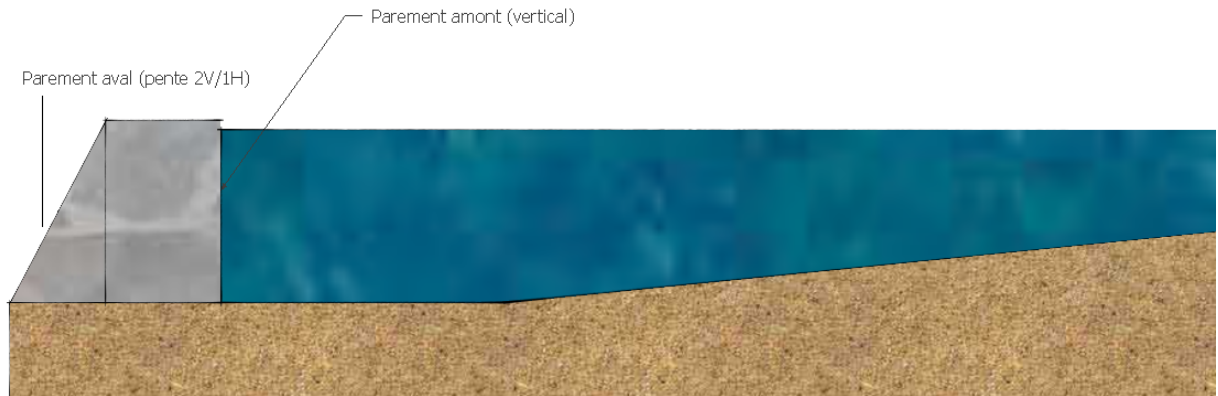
Profil en long de la retenue et coupe sur barrage
